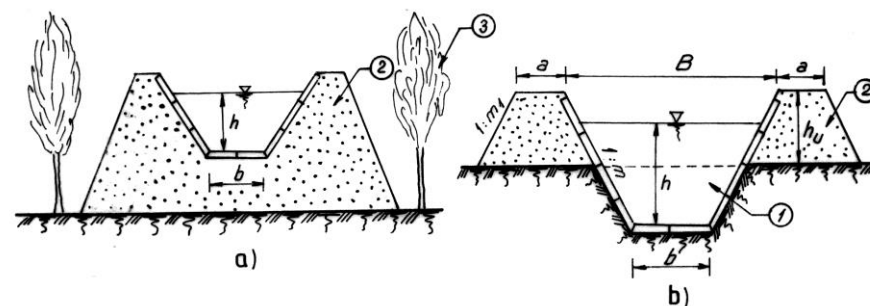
Secțiuni transversale trapezoidale simple, în:
